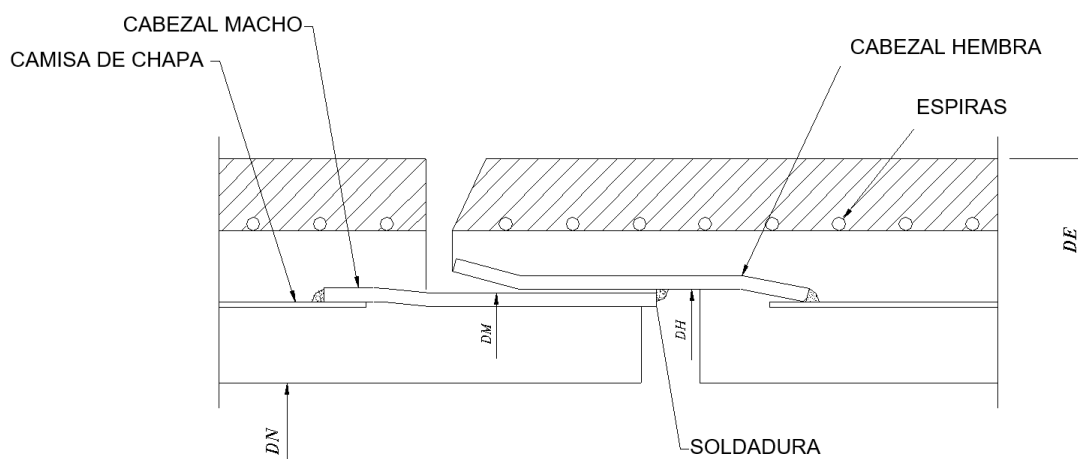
Tubería de hormigón postesado “de camisa embebida”.
